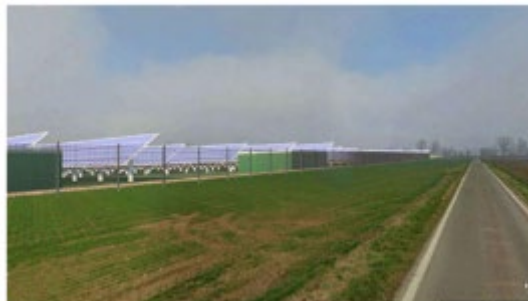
Foto inserimento impianto senza mitigazione vista strada
